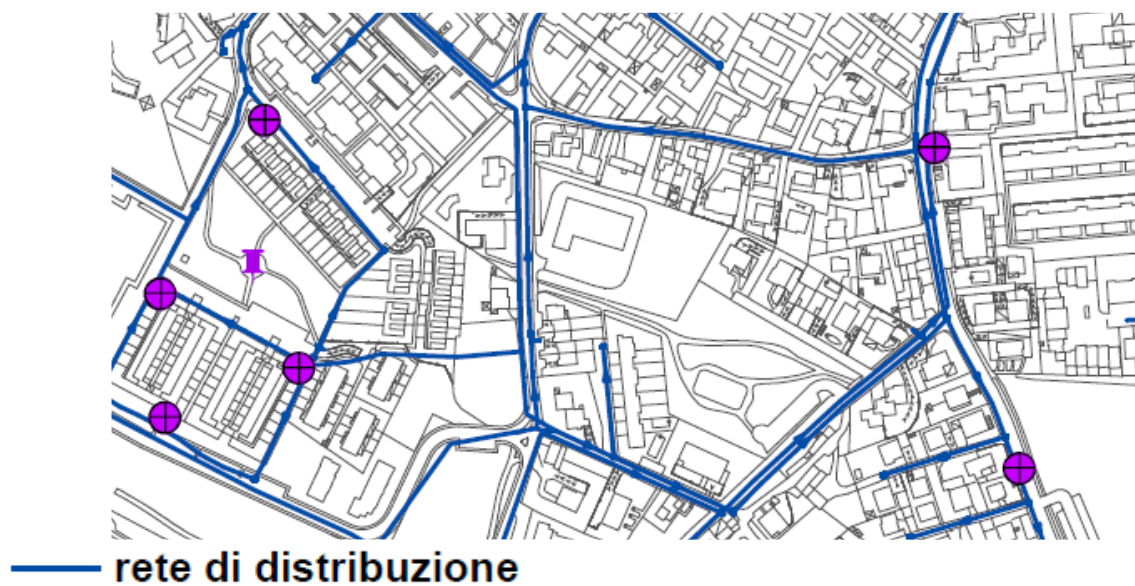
Estratto della tav. 1.3 Fognatura (estratto dal piano sottoservizi del PGT)
